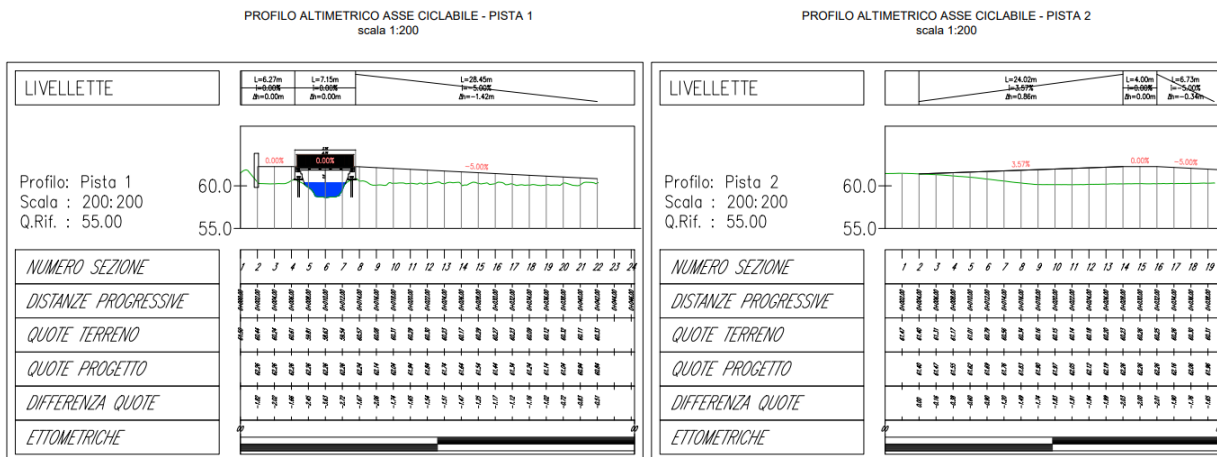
Profilo altimetrico – Ponte pedonale 1C
